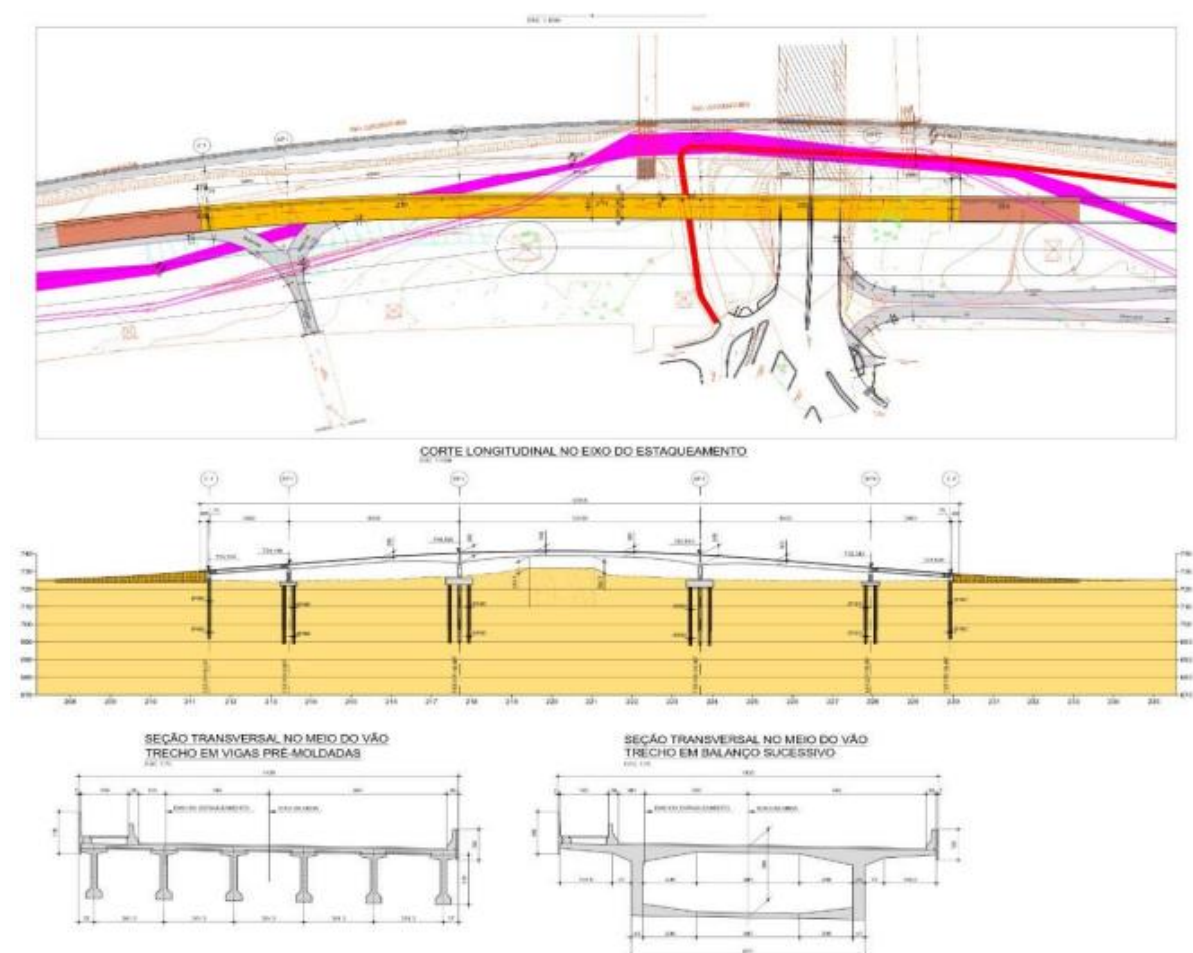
Trecho viaduto sobre a Ponte do Socorro e perfil, objeto de intervenção.
